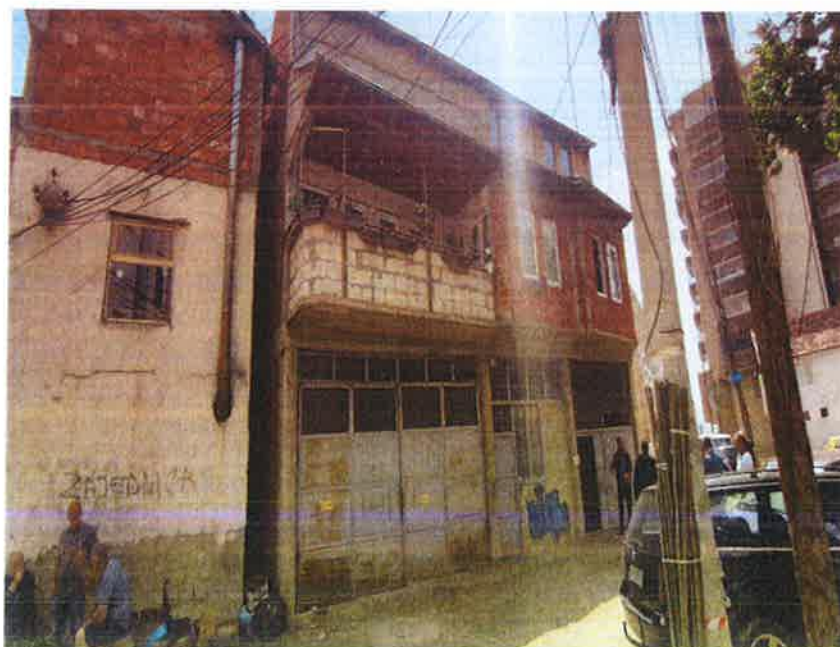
Foto e fasadës veriore të objektit shtëpi banimi -maj 2024
